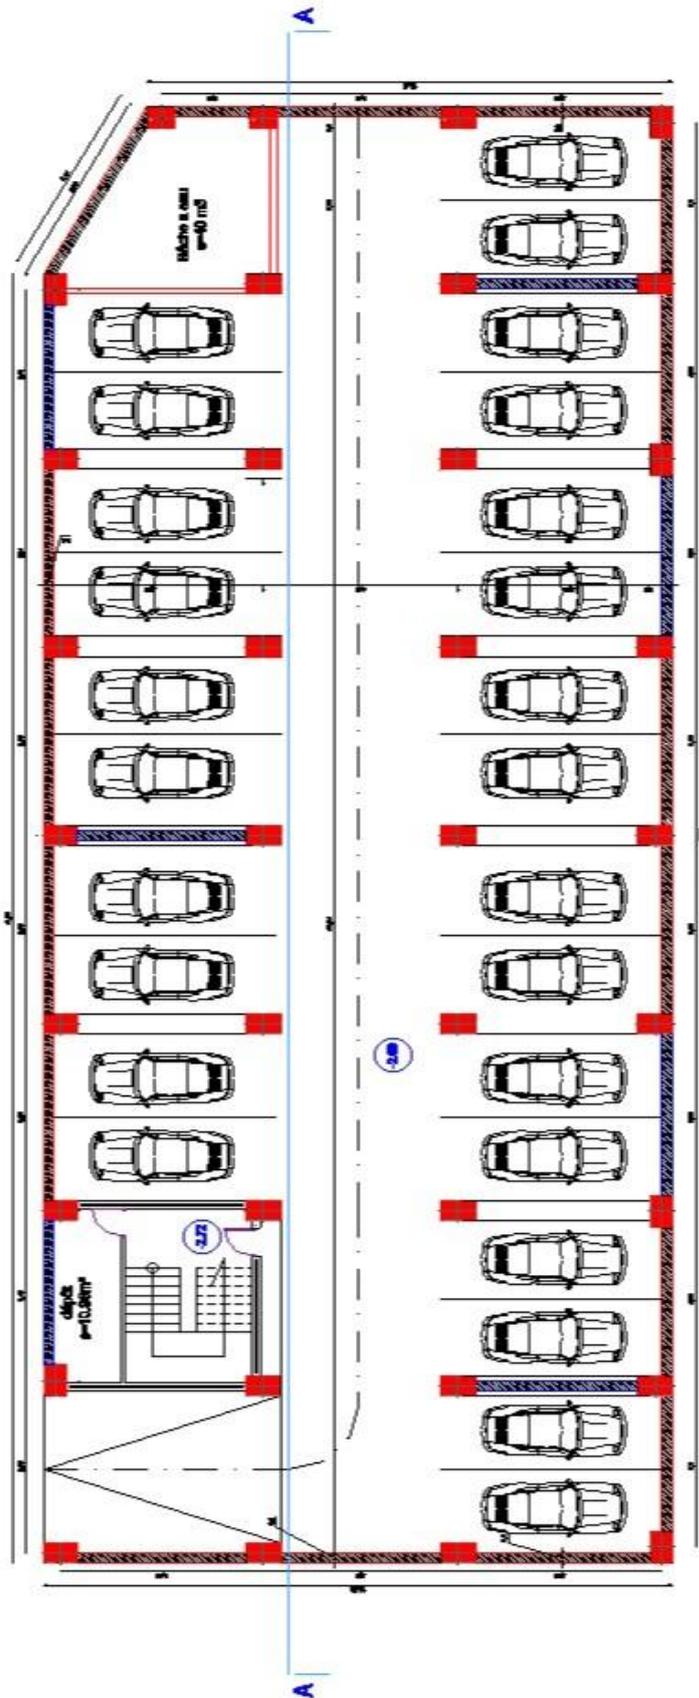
Plan de sol sous-sol (parking) niv -02.69
